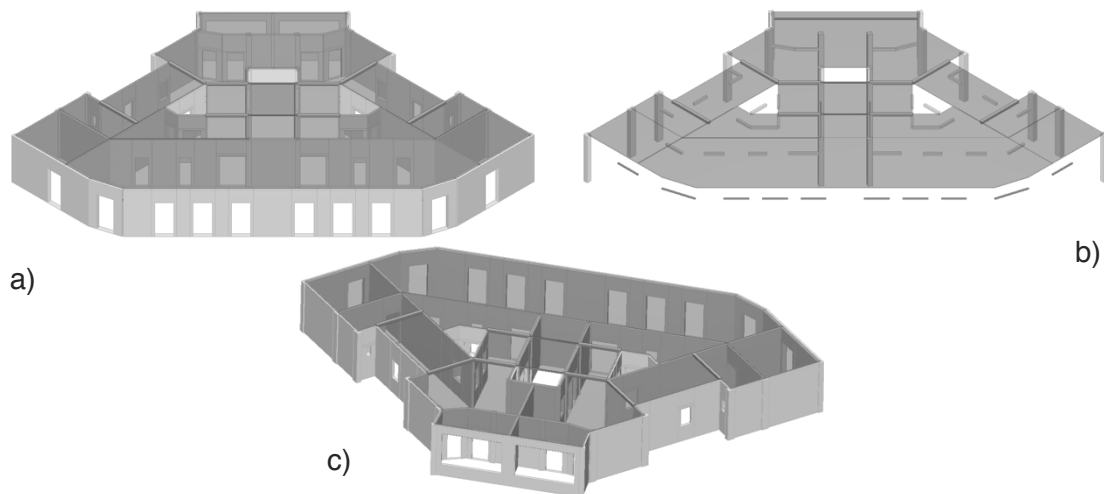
Modelo Tremuri edificio ED-04 planta tipo. a) Vista isométrica fachada principal. b) Vista isométrica fachada principal sin muros. c) Vista isométrica fachada trasera
